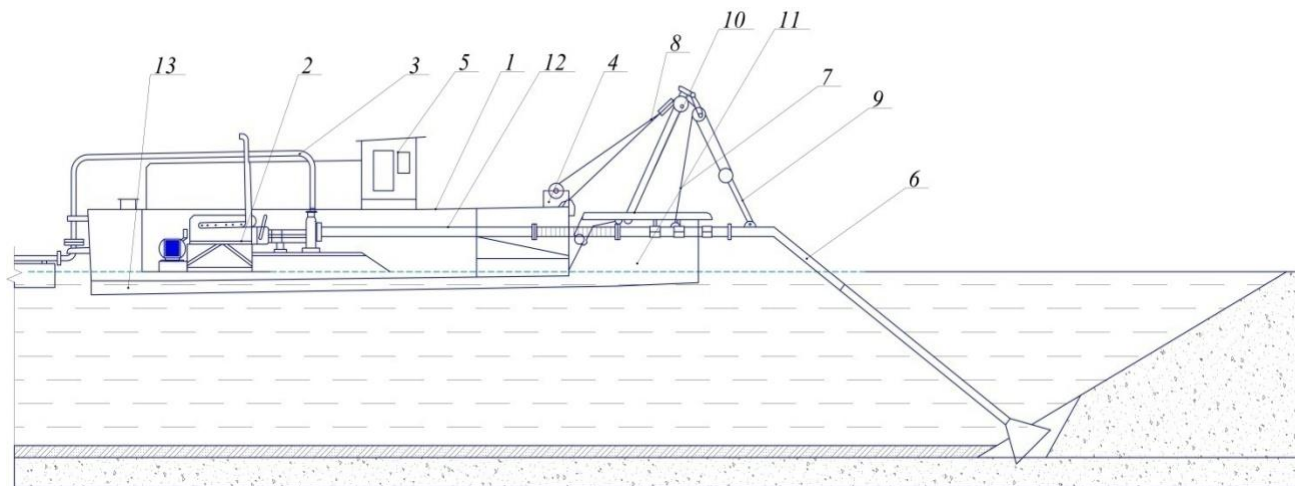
Схема плавучей землесосной установки ПЗУ-8М: 1 — корпус; 2 — двигатель 3Д6СН; 3 — напорный пульпопровод; 4 — лебедка подъема рамы рыхлителя; 5 — рубка управления; 6 — всасывающий патрубок; 7 — укосина; 8 — подвеска укосины; 9 — полиспаст подвески рамы всасывающего патрубка; 10 — подъемная рама рыхлителя; 11 — понтон боковой; 12 — напорный трубопровод; 13 — понтон центральный
